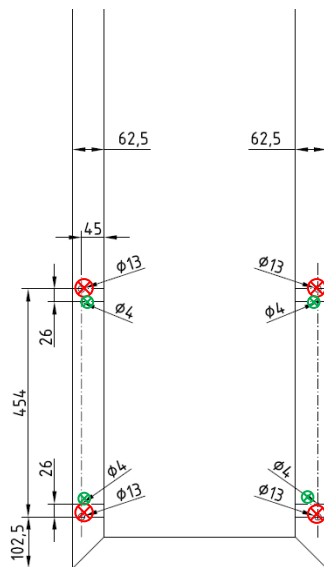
Befestigung des Grundprofils an das Fensterprofil für eine horizontale Lagerung (exemplarisch, hier mit je 4 Befestigungspunkten)
